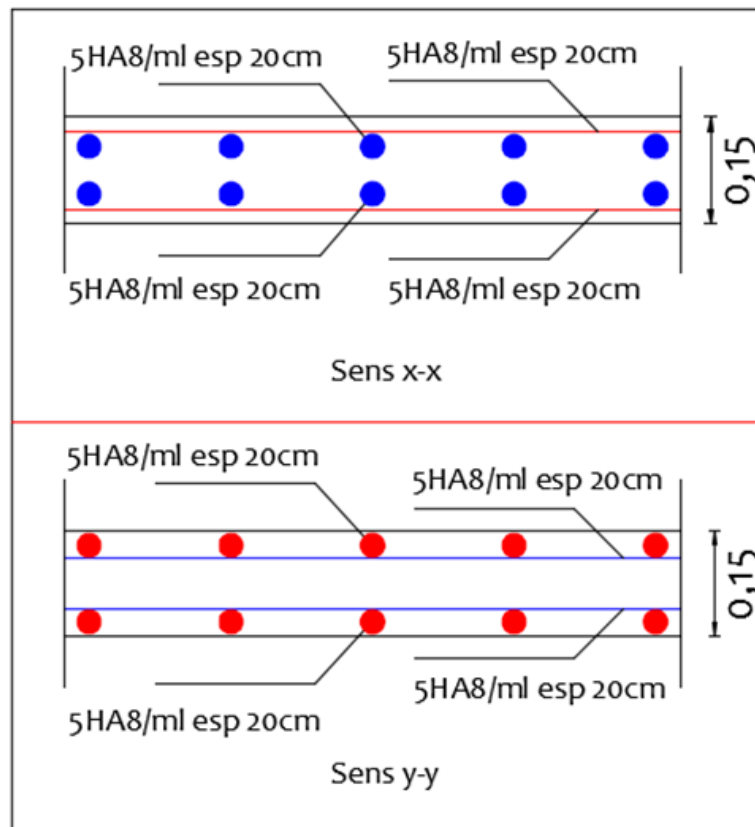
Schéma de ferrailage de la salle machine [23].
